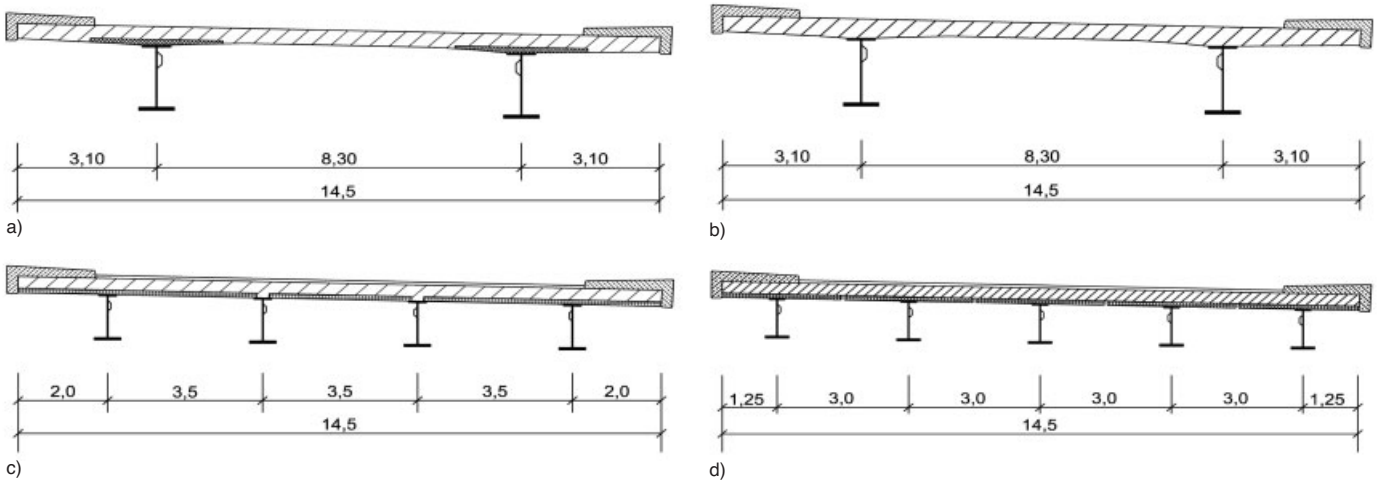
Varianten der untersuchten Verbundbrückenquerschnitte – Brückenstützweite 45 m, a) Typ 1: Fertigteilverbundträger mit Ortbetonplatte; b) Typ 2: Stahlträger mit Ortbetonplatte; c) Typ 3: Stahlträger mit Betonfertigteilen und Aufbetonplatte; d) Typ 4: Fertigteilverbundträger mit Aufbetonplatte
